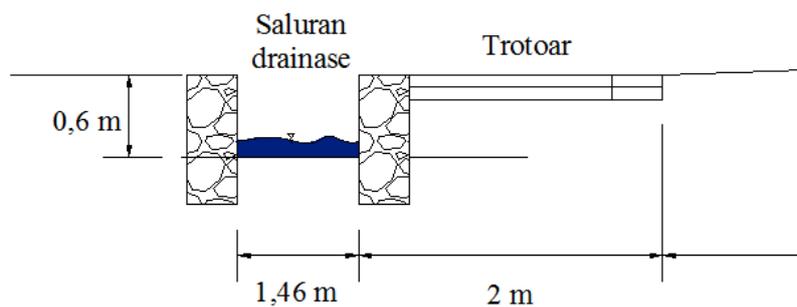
Potongan Melintang Saluran Eksisting A-A
